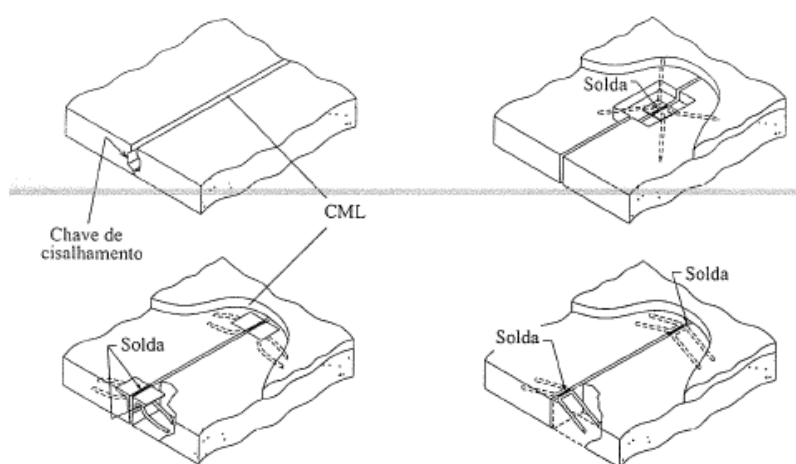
Ligações laje-laje na direção longitudinal [6]
